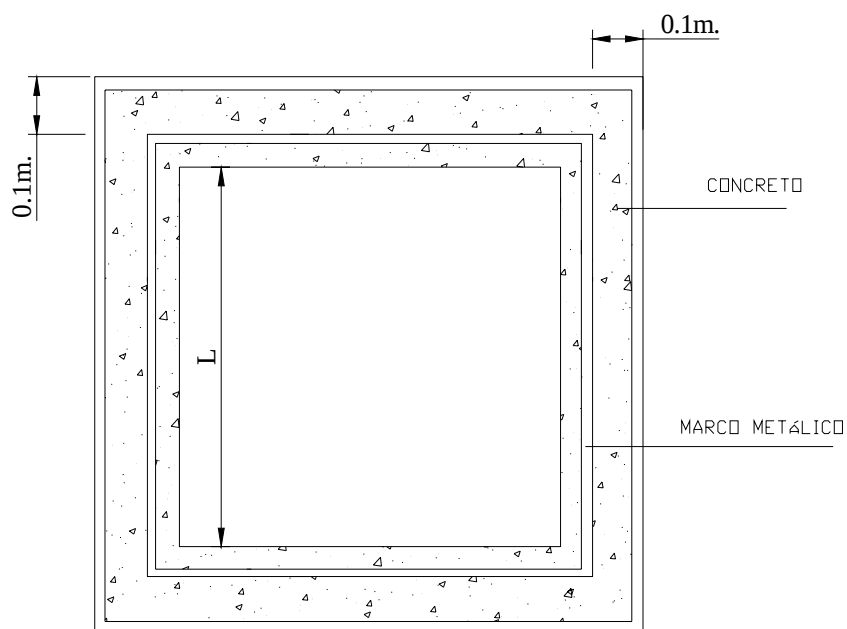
Caja de inspección sencilla en M.T. Vista de planta caja con marco.
